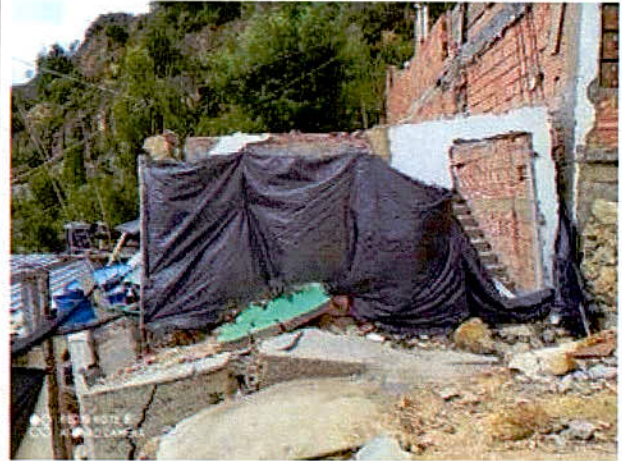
Vista de las viviendas V16 y V17, ubicadas en la zona media de la ladera inspeccionada, en donde se observa que el suelo donde se emplazan continúa desplazándose.
